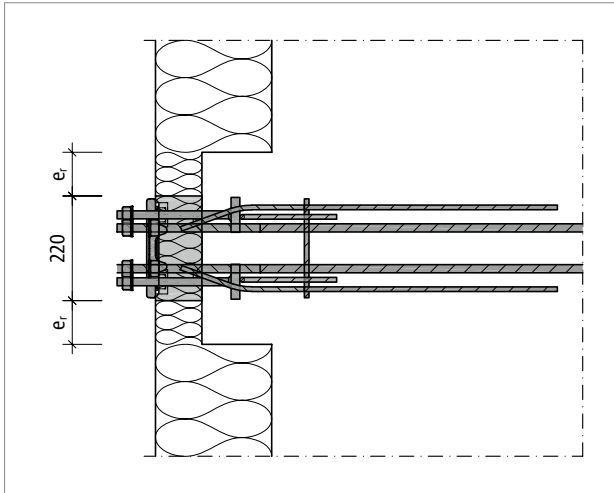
Schöck Isokorb® XT type SK : Distances aux bords
